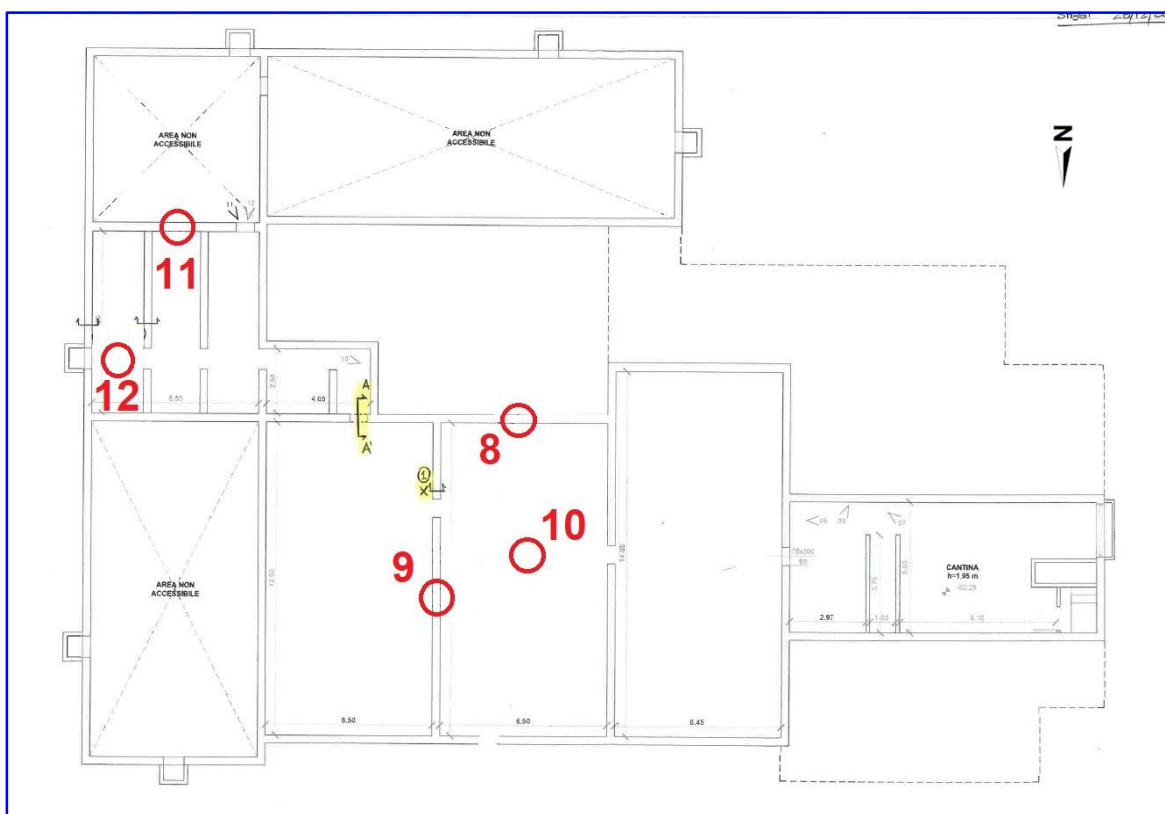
Planimetria piano interrato con ubicazione delle 5 zone esaminate
